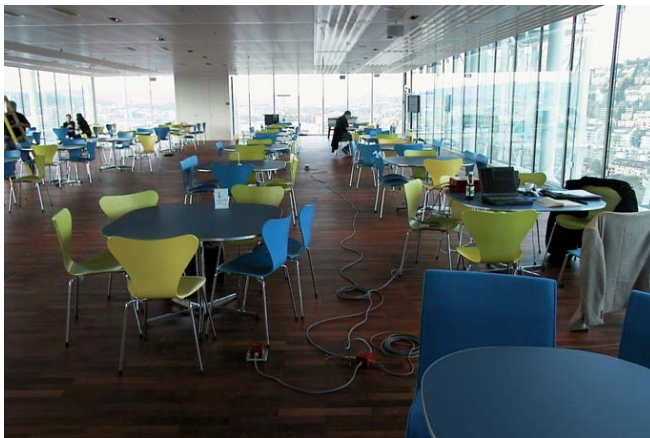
Personalrestaurant mit Geschossdecke aus Leichtbeton
